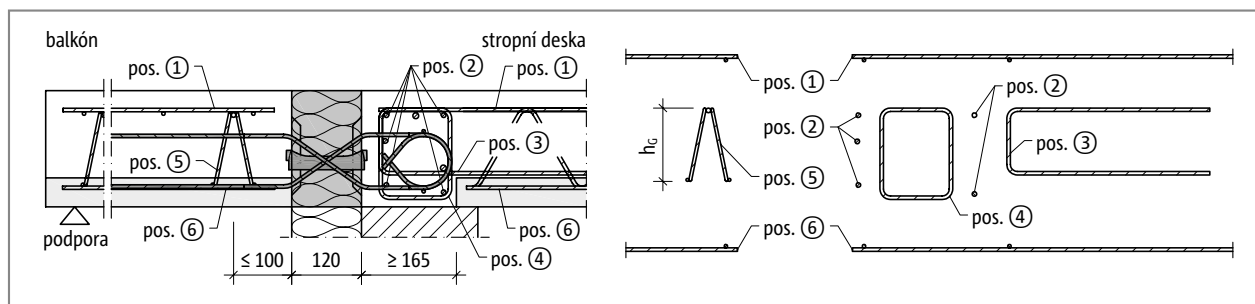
Schöck Isokorb® typ QXT60+QXT60 až QXT90+QXT90: Napojovací stavební výztuž
